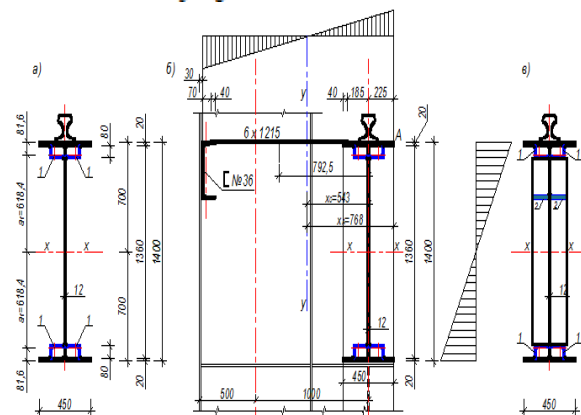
Сечение подкрановой балки: а) усиление по способу III; б) к расчету подкрановой балки; в) подрезка поперечных и установка продольных ребер жесткости: 1 – $\angle 125 \times 80 \times 8$; 2 – $\angle 150 \times 10$
